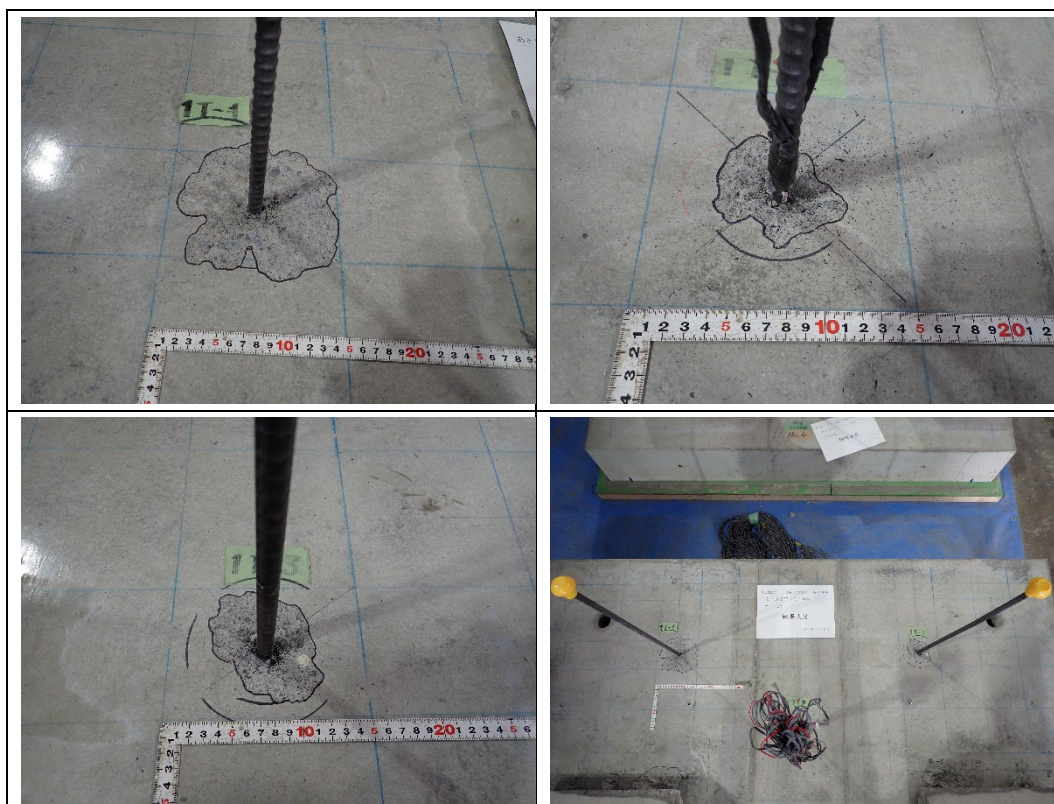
あと施工アンカー単体実験破壊状況 (1T-1～1T-3)
